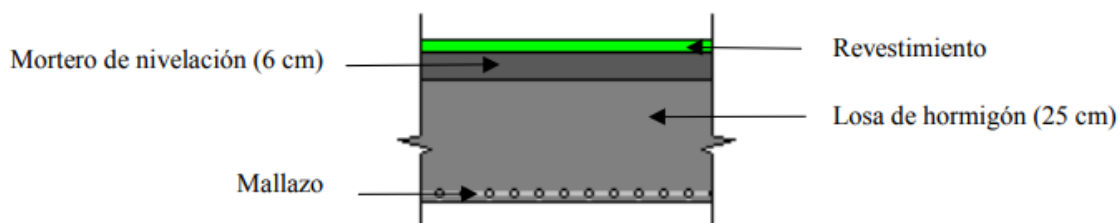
Entrepiso en bovedillas de hormigón 25 cm
